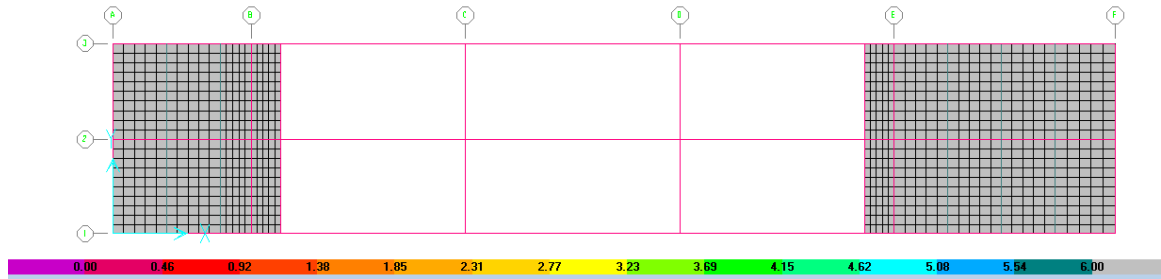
Planta nivel mezzanine módulo de acceso estación 17 costado occidental aplicación de la carga viva (6,0 kN/m<sup>2</sup>)
